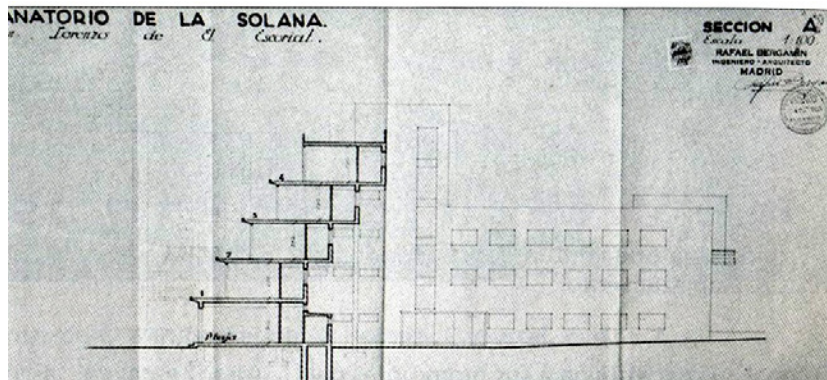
Planta del proyecto del Sanatorio de La Solana, Madrid
